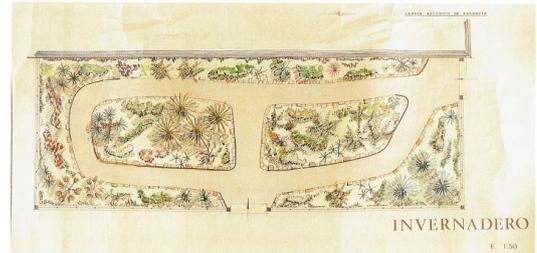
Proyecto de jardinería para la Estufa Tropical.
